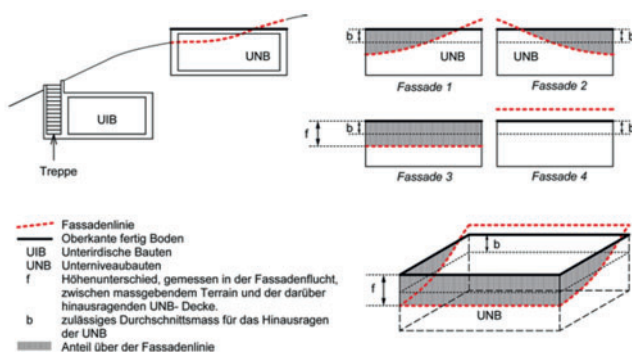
Unterirdische Bauten, Unterniveaubauten gemäss BMBV
